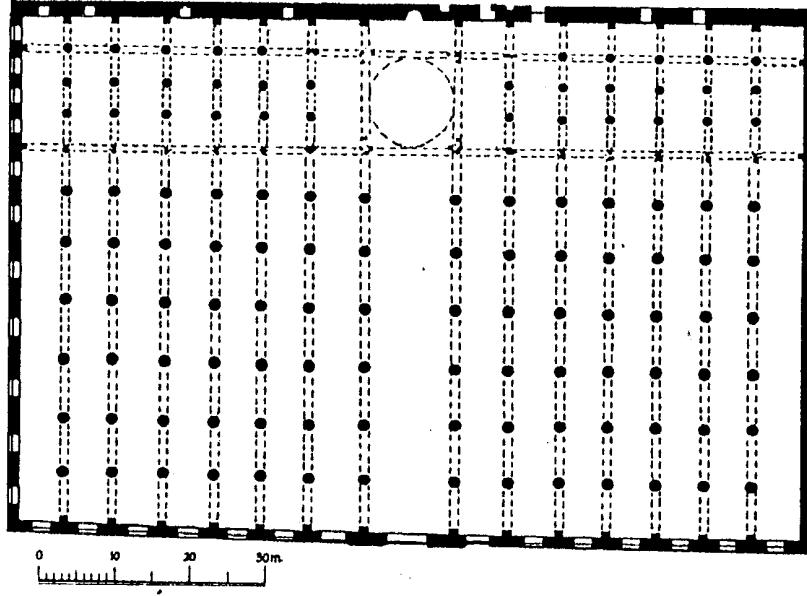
مسقط أفقي لجامع الرسول بالمدينة المنورة في عهد الوليد بن
